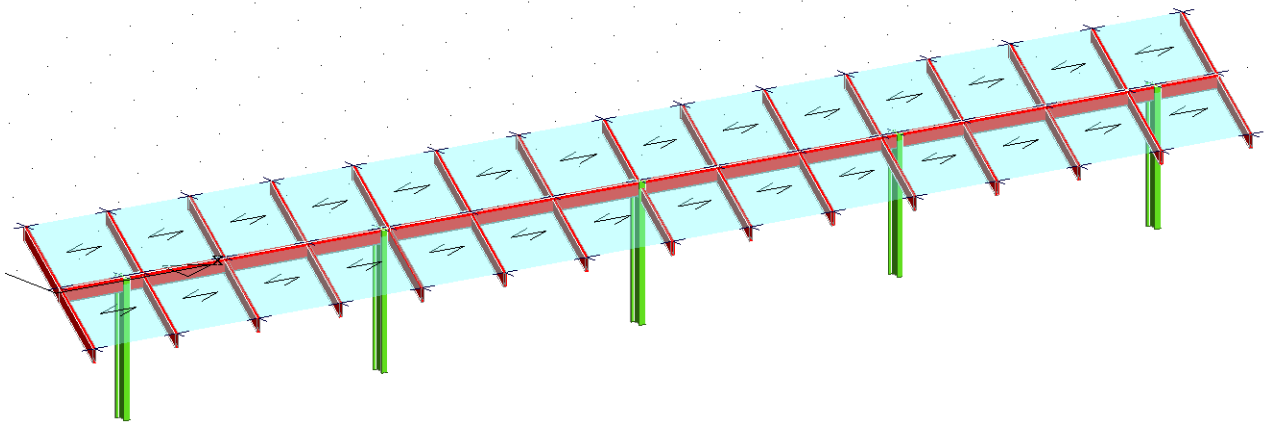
Vista assonometrica modello strutturale portale TIPO C inclinazione fissa 33°
